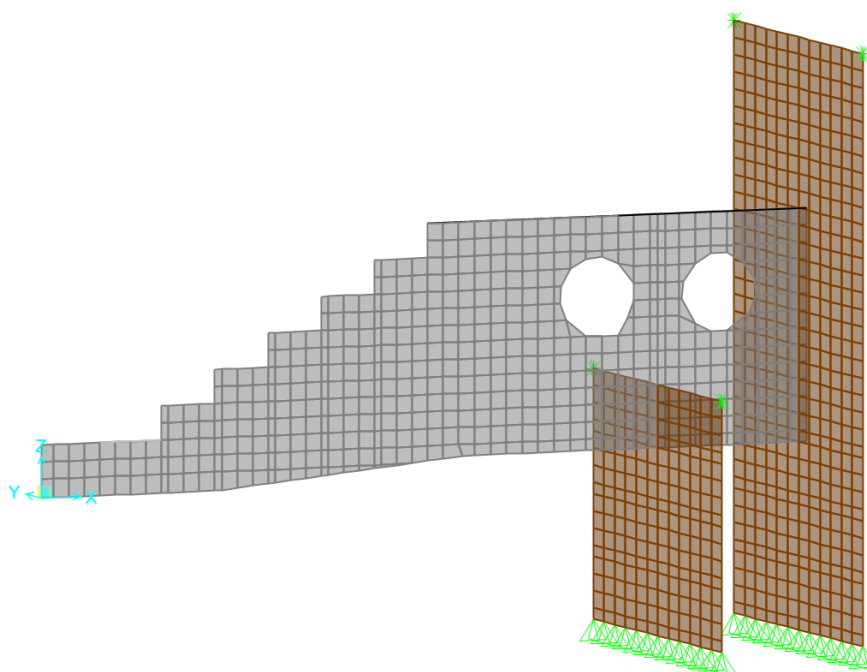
Modelo tridimensional: Viga Parede tipo do piso 2
